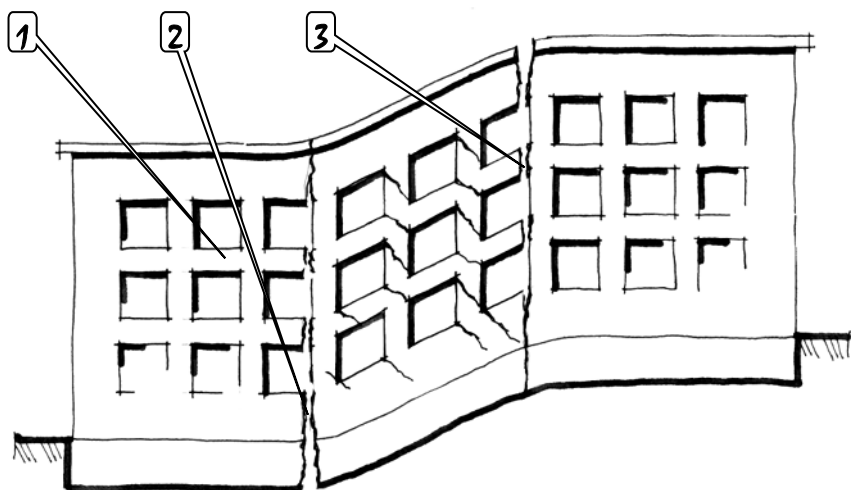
Пошкодження будівлі при уступі ґрунтової основи: 1 – деформована будівля; 2 – зони появи і розвитку тріщин
